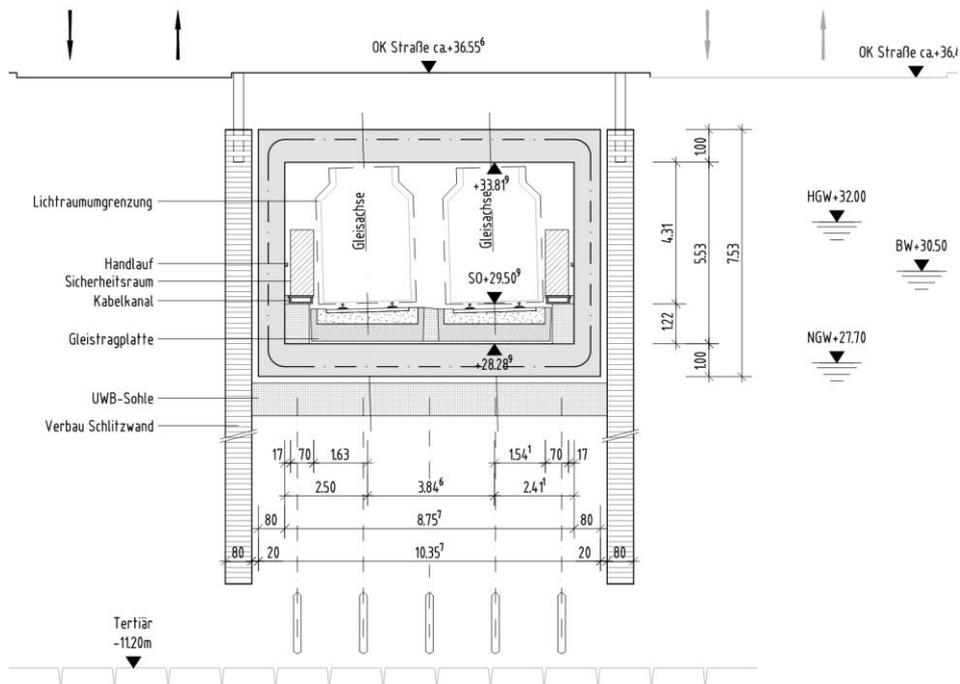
Ansicht – Einbindetiefe der Schlitzwände im Bereich Baugrube „Rampe + Tunnelstrecke“
